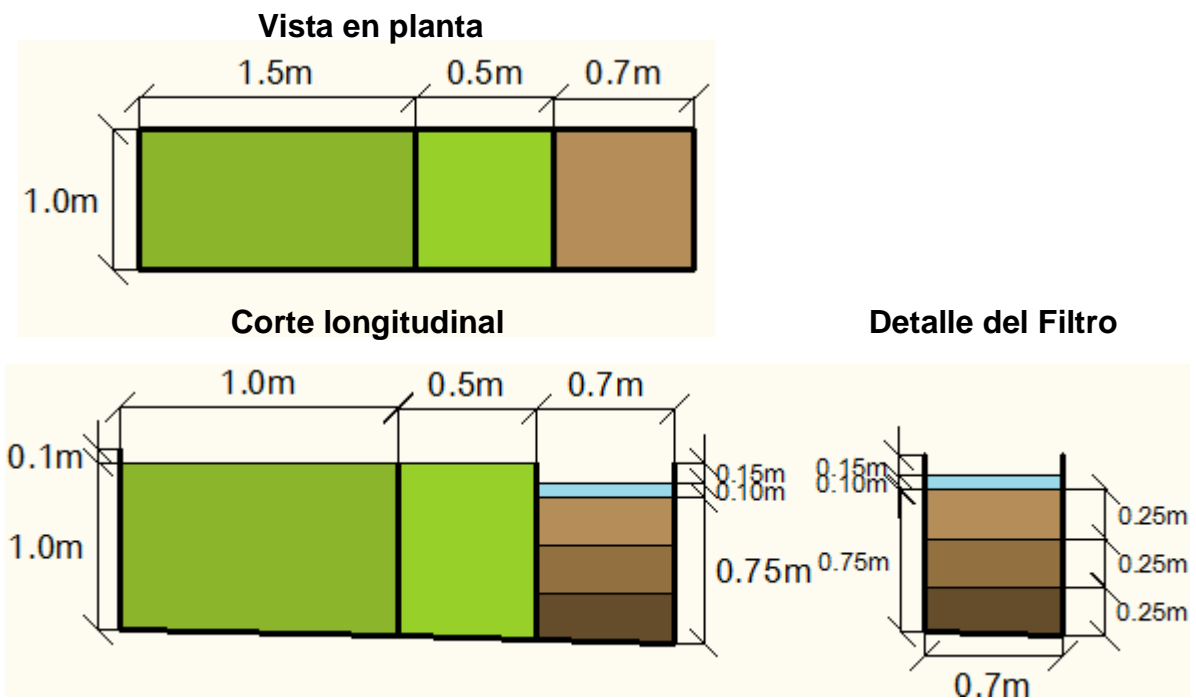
Vista planta, corte longitudinal y corte transversal del TSAM.
